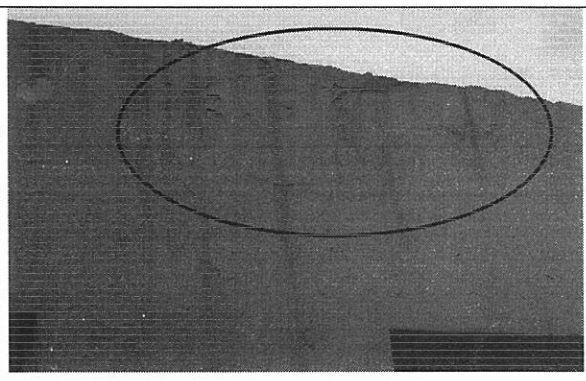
Fisuras en la parte superior del muro del costado norte
